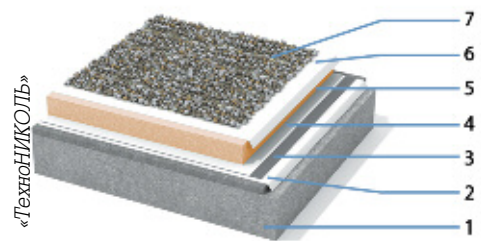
Стандартная конструкция балластной инверсионной кровли: 1 – бетонное основание; 2 – геотекстиль; 3 – гидроизоляционная мембрана (ПВХ); 4 – геотекстиль; 5 – теплоизоляция; 6 – разделительный слой (геотекстиль); 7 – балластный слой гравия.
